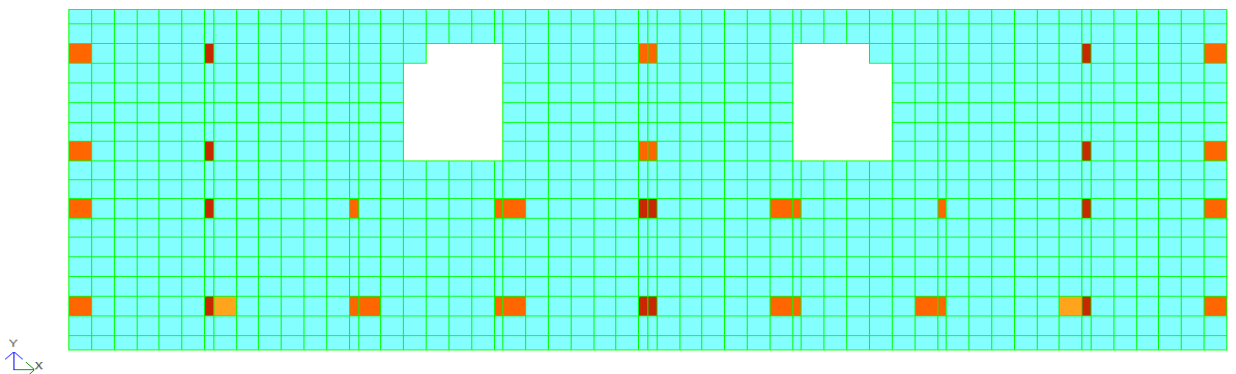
Площадь поперечной арматуры вдоль оси Y
